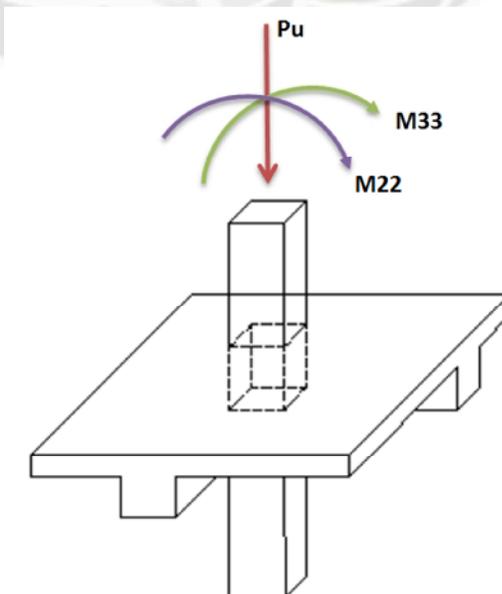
Esquema de Columna con las Cargas que Recibe.
